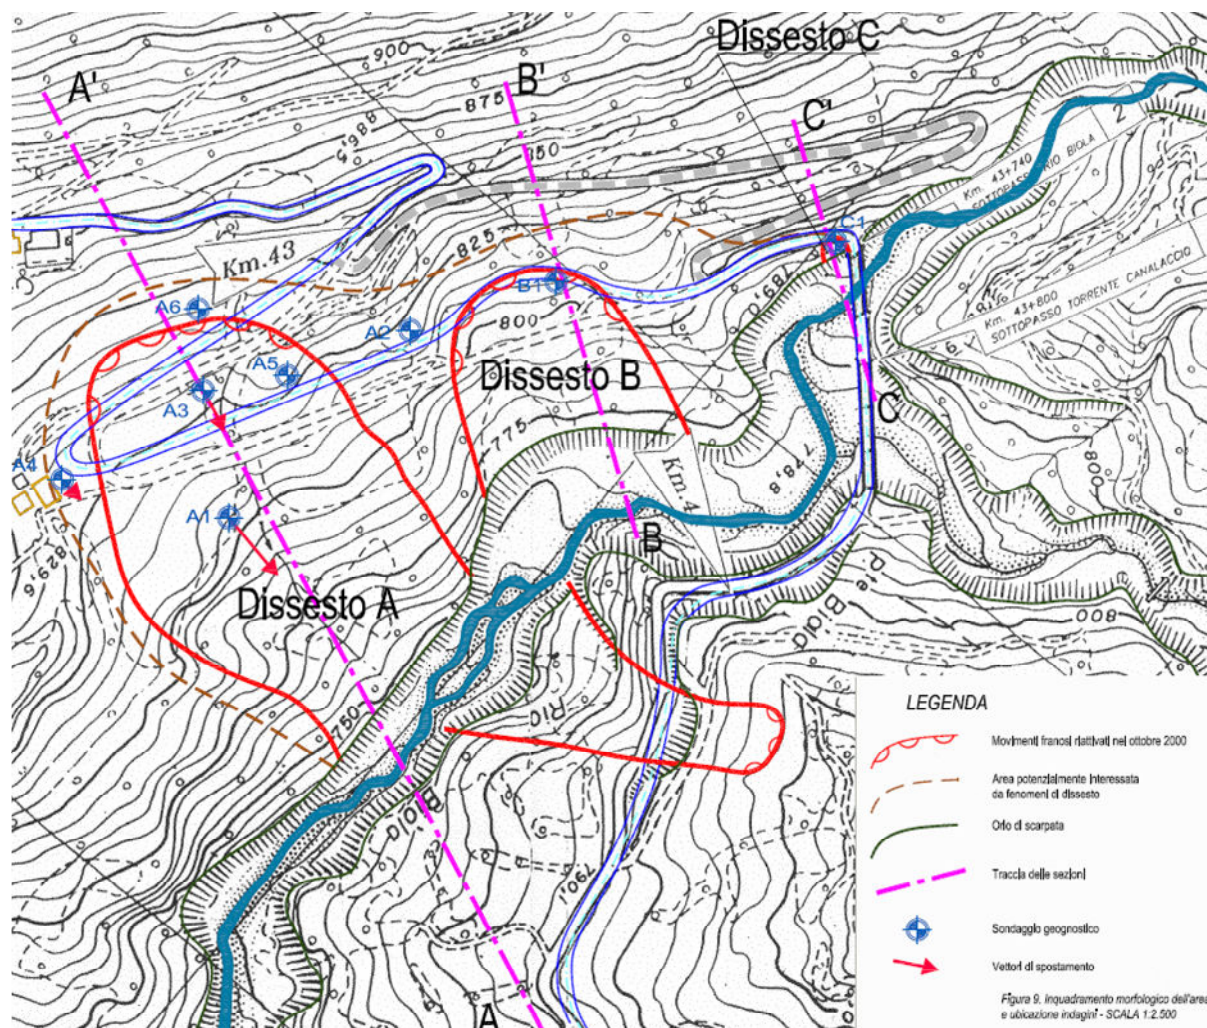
Perimetrazione planimetrica dei dissesti presenti sul versante.
